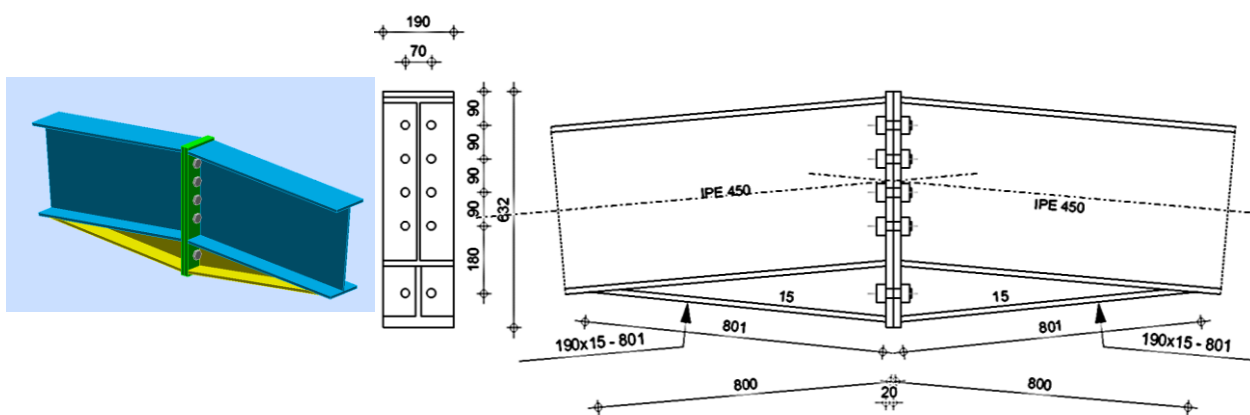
Representação da ligação entre travessas para o pórtico tipo 1
